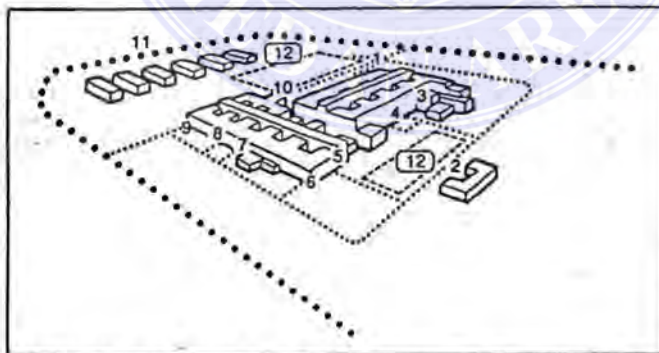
Bentuk Rumah Sakit Compact Plan
